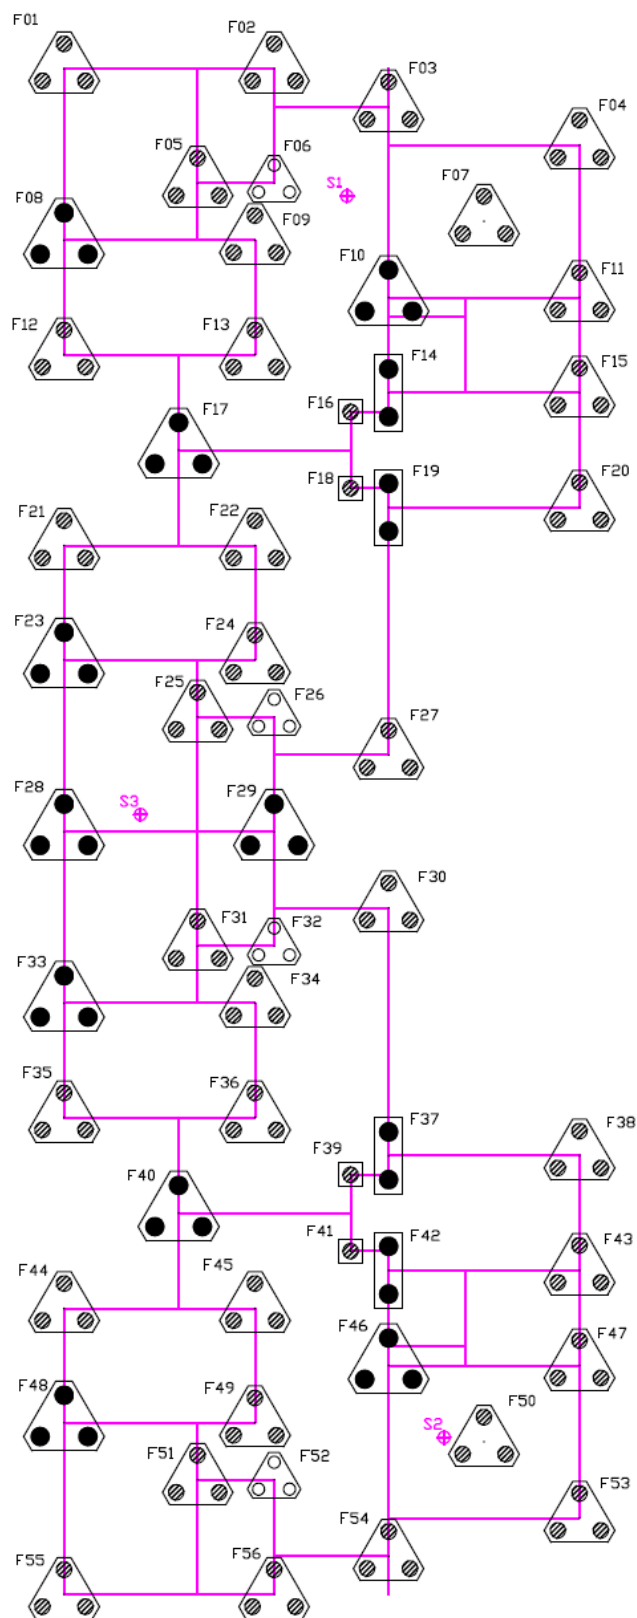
Planta de fundação profunda para o edifício alongado.
